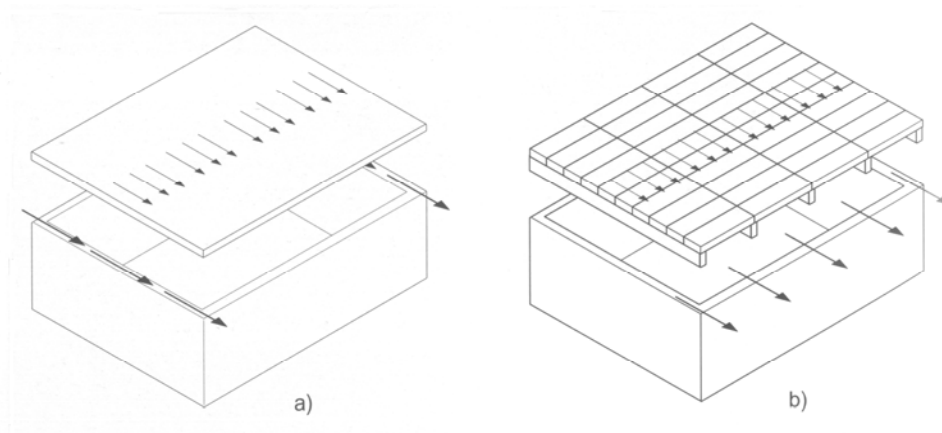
Comparación de los sistemas de estructurales basados en los muros de carga y vigas (a) y los sistemas estructurales a base de muros de carga y losas de concreto. Tomado de *Ingeniería Estructural de los Edificios Históricos*.
